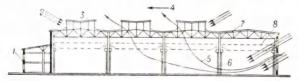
Вертикальный поперечный разрез (схема) одноэтажного многопролётного пром. здания: 1— пристройка для бытовых помешений; 2— направление светового потока; 3— фонарь верхнего света; 4— направление ветра; 5— воздушные токи; 6— колонна каркаса; 7— покрытие; 8— мостовой кран.
